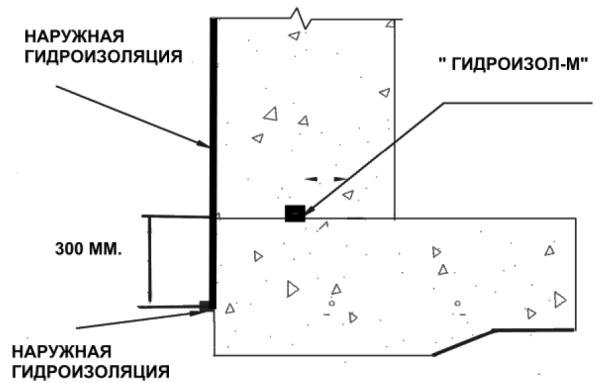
Монтаж шнура на лифтовых приемках без наружной гидроизоляции оголовка.
